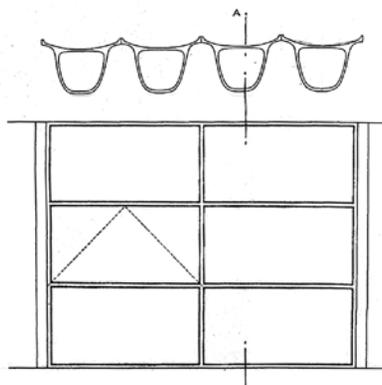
Instituto Núñez de Arce. Detalle constructivo.
